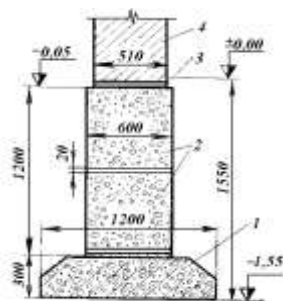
Стрічковий фундамент з прямокутних блоків із залізобетонною подушкою для несучих стін
